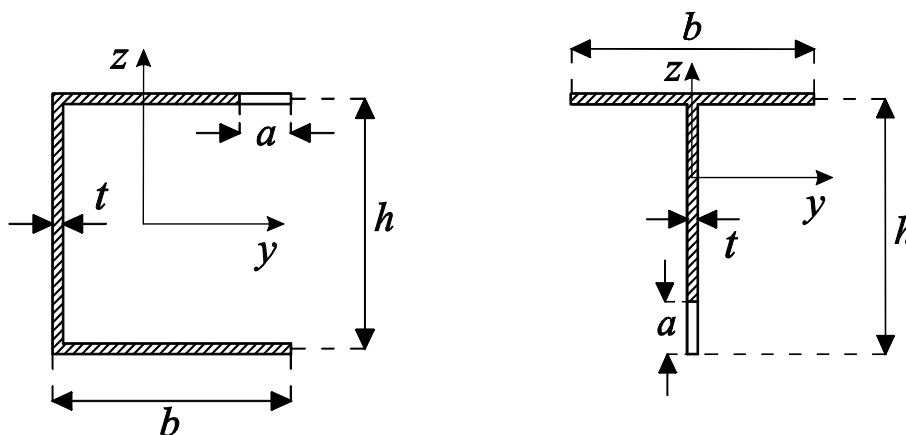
Secciones transversales estudiadas con su correspondiente disposición de fisura.
